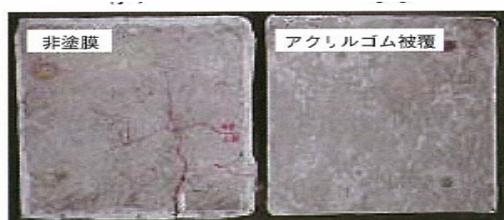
アルカリシリカ反応ひび割れの抵抗性
